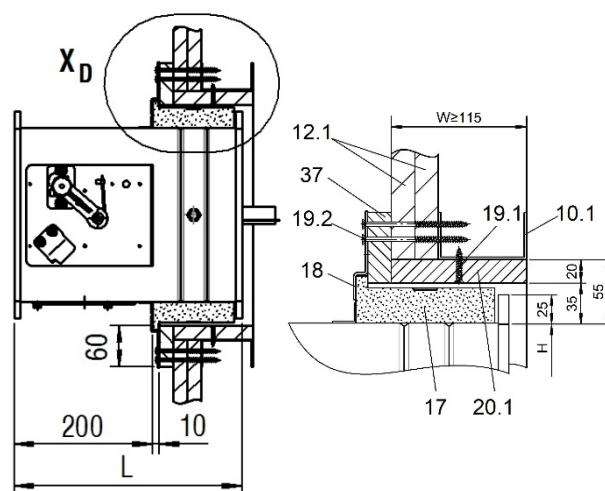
montaggio a secco con telaio a incasso ER-P1 in parete divisoria leggera
